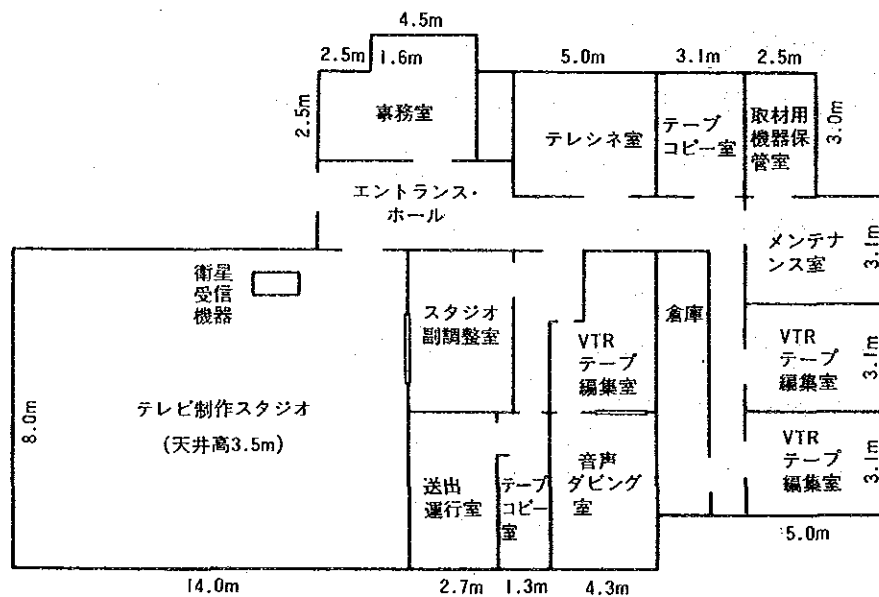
既存ラオス国立テレビ局演奏所平面図
